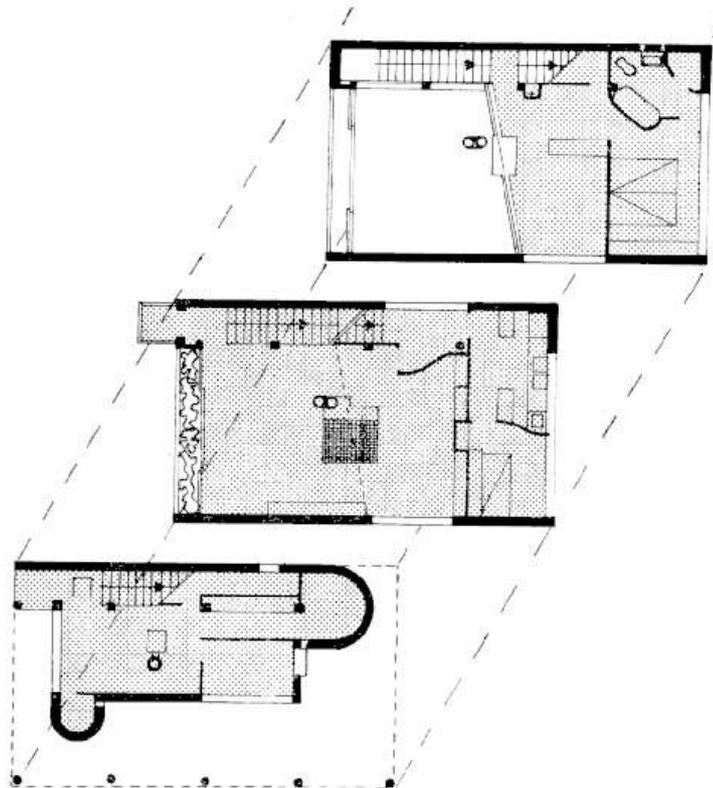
plantas pavimentos térreo, 1 e 2 da casa A de Le Corbusier
